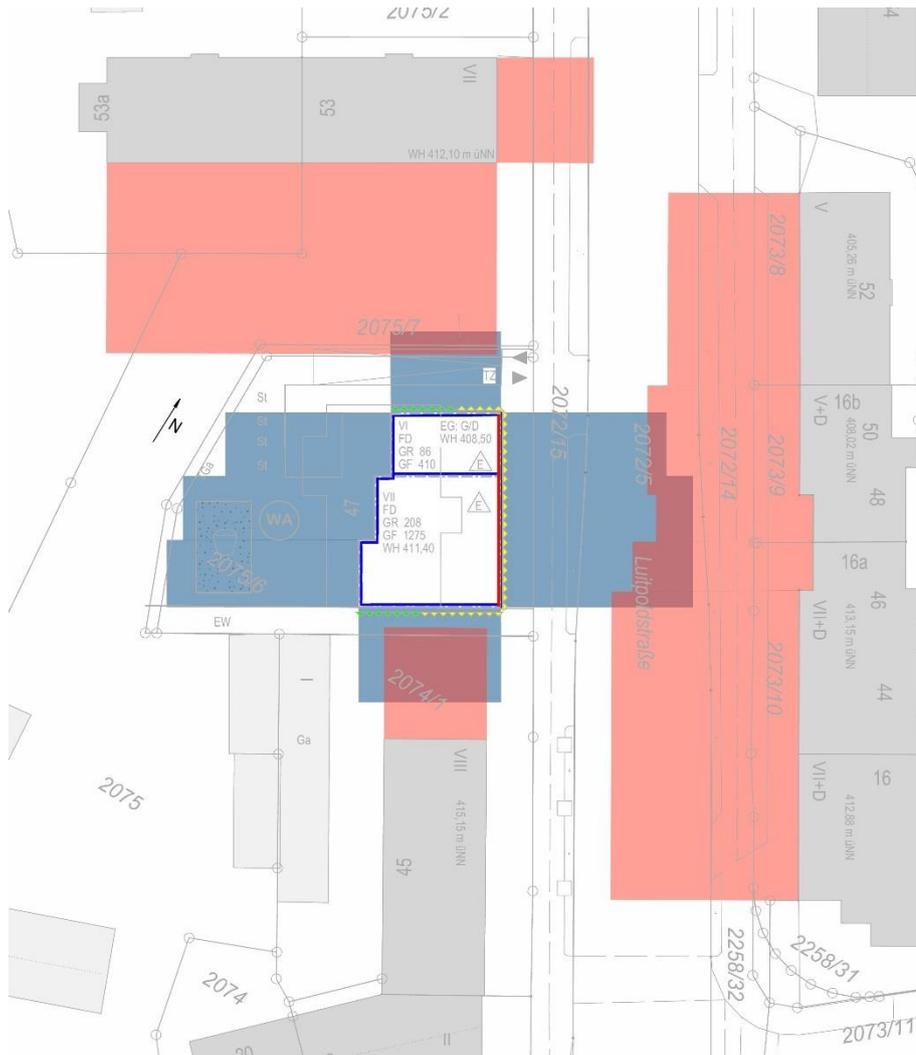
Themenplan Abstandsflächen. Blaue Flächen: Abstandsflächen, die sich durch das Bauvorhaben ergeben. Rote Flächen: Abstandsflächen, die sich durch die Nachbarbebauung ergeben. EGL 02/2018, unmaßstäblich
